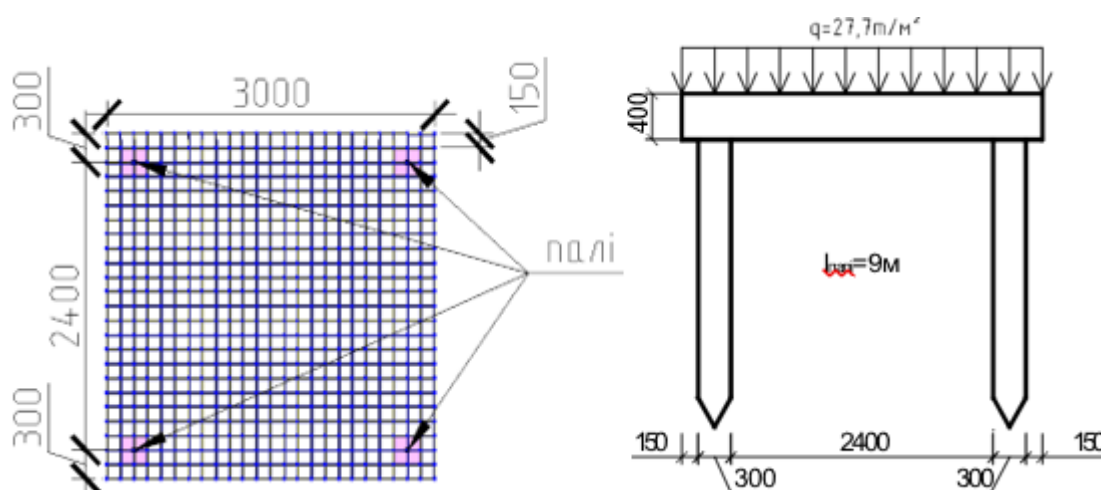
Розрахункова схема плитно-пального фундаменту
